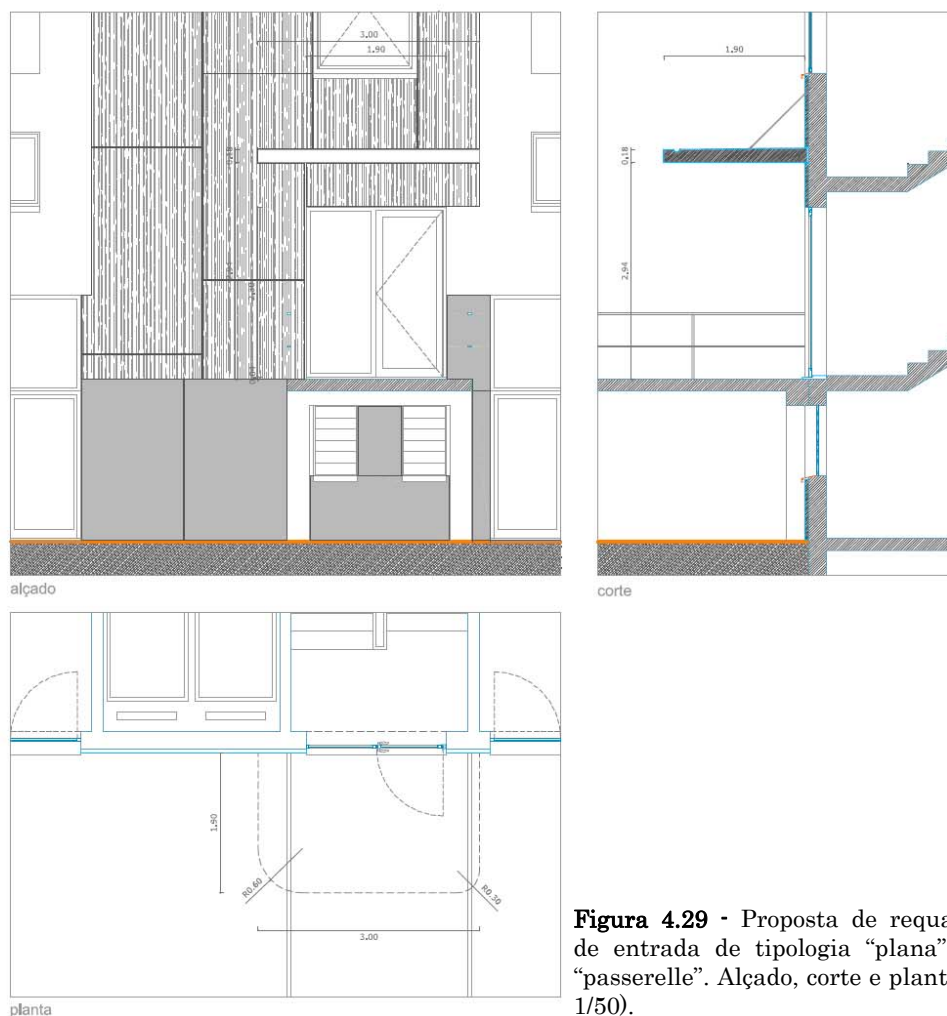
Proposta de requalificação de entrada de tipologia “plana” do tipo “passerelle”. Alçado, corte e planta (escala 1/50).
